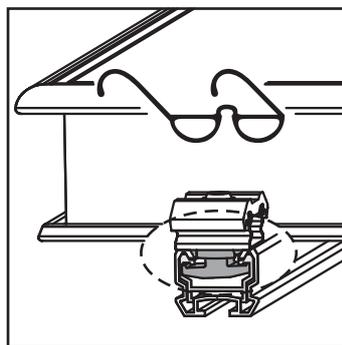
Controllare la posizione del profilato di serraggio inferiore
